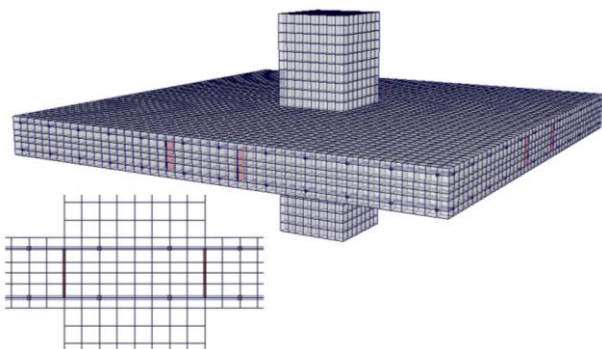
Фрагмент уточненной модели узла сопряжения колонны и плиты перекрытия с жёсткой арматуры в виде четырех пластин
